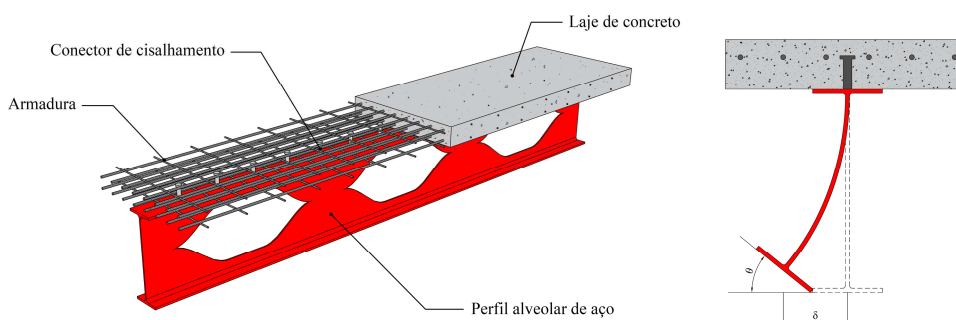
Viga mista de aço e concreto com perfil alveolar senoidal.
